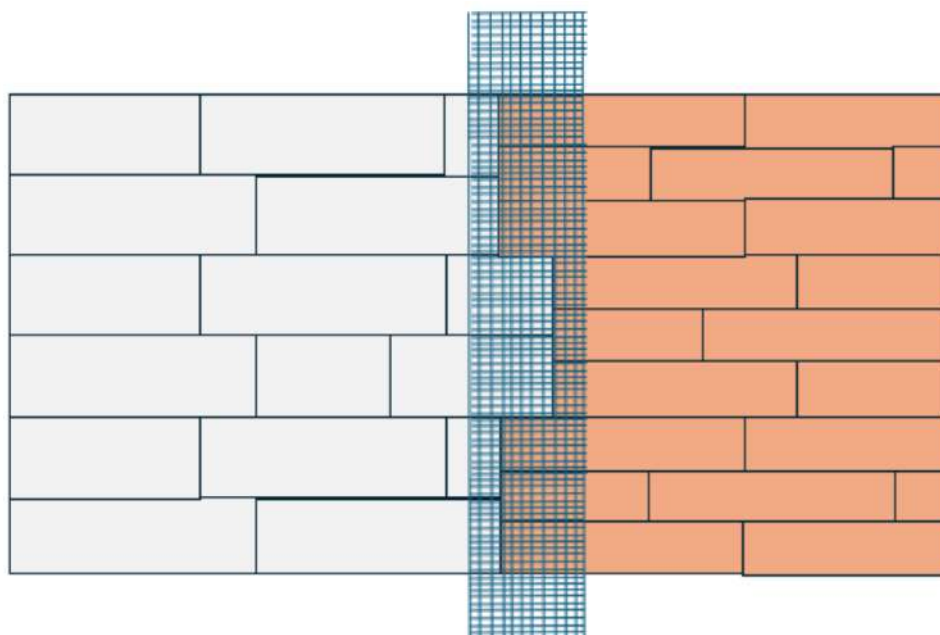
Plan de jonction horizontal-horizontal : Revitherm EP PSE 1,2 m x 0,6 m / Revitherm EP RESOL 1,2 m x 0,4 m
